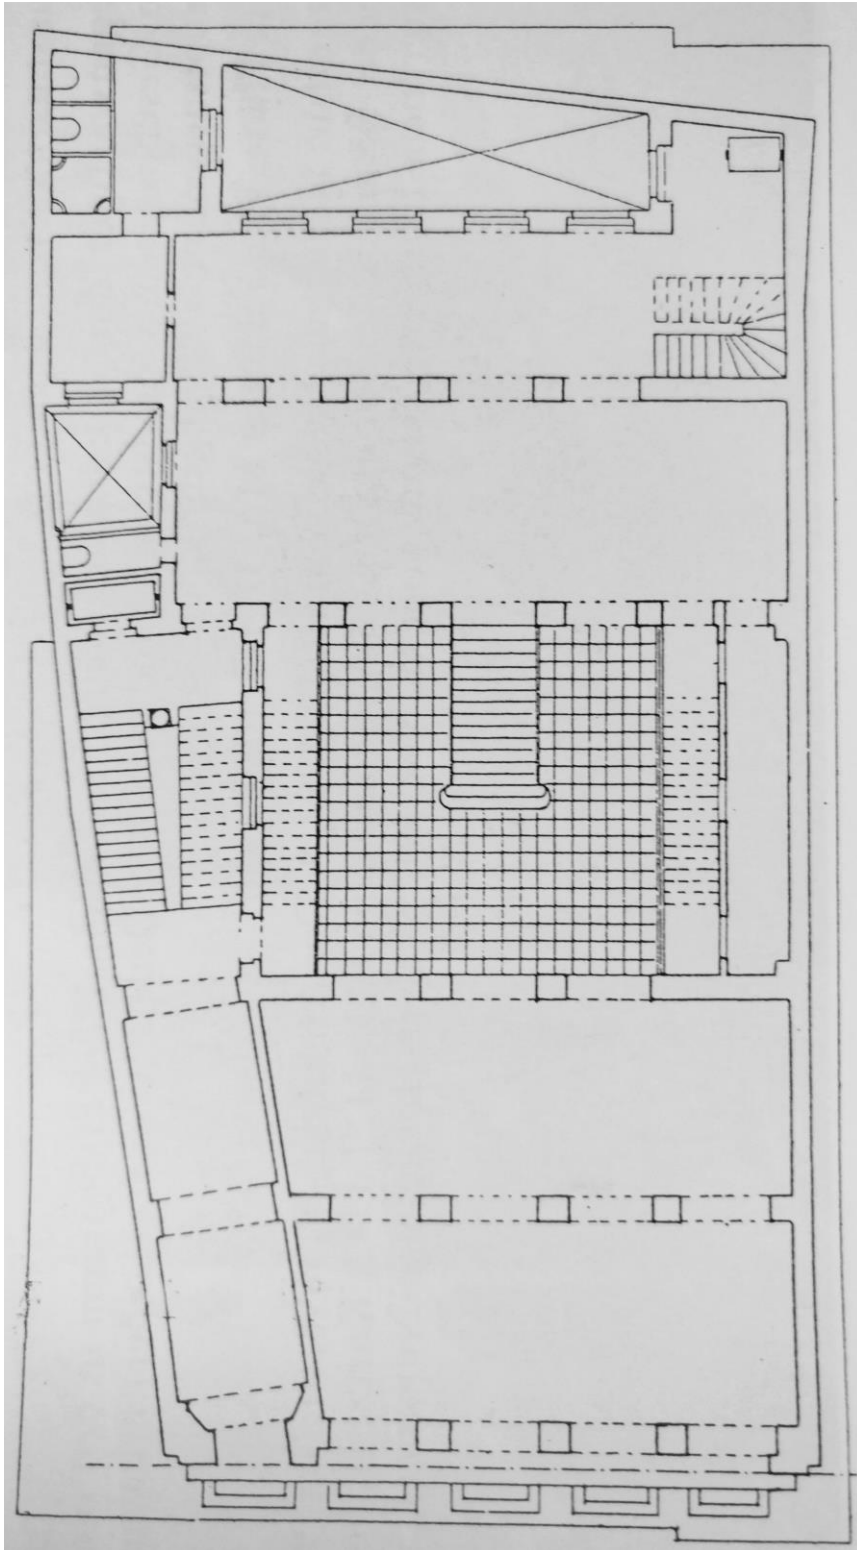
Otto Wagner, Warenhaus Neumann, Grundriss Erdgeschoß, 1896
